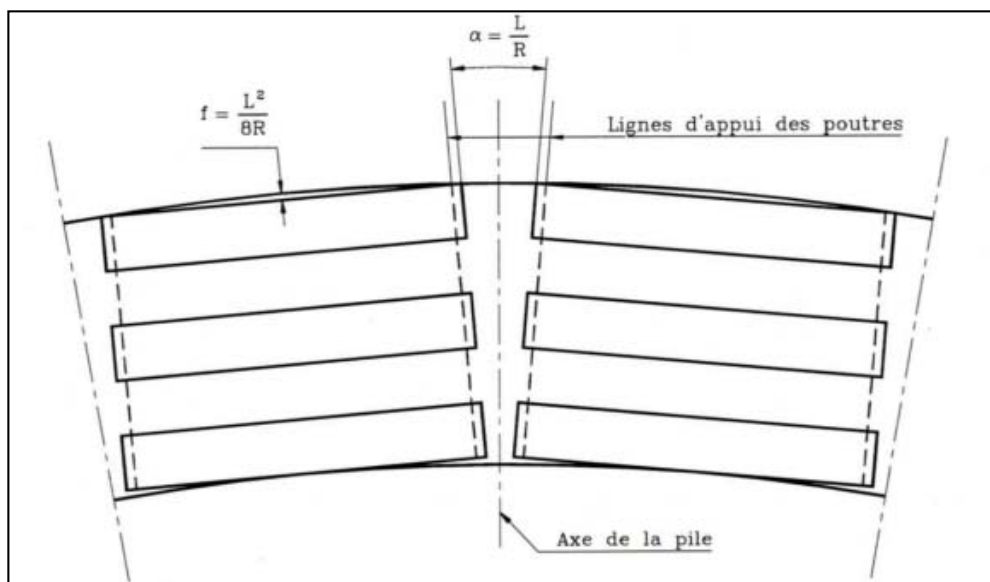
Disposition des travées d'un ouvrage courbe [6]
